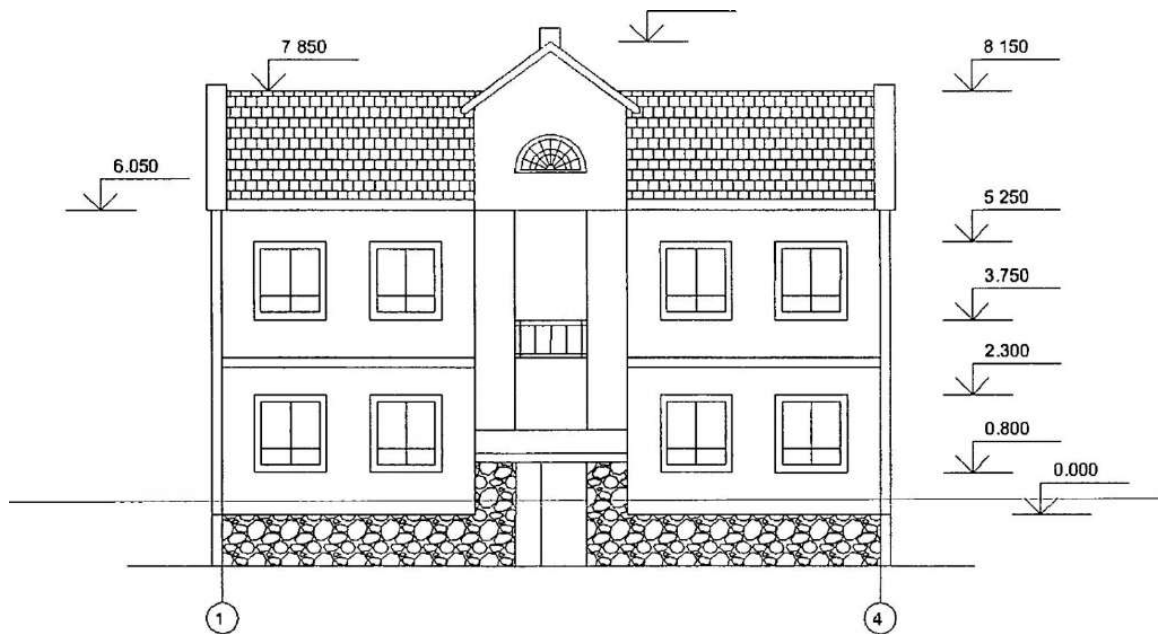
Приклад головного фасаду індивідуального житлового будинку, що зводиться за вдосконаленою технологією монтажу з оптимізованих індустриальних сендвіч-панелей
